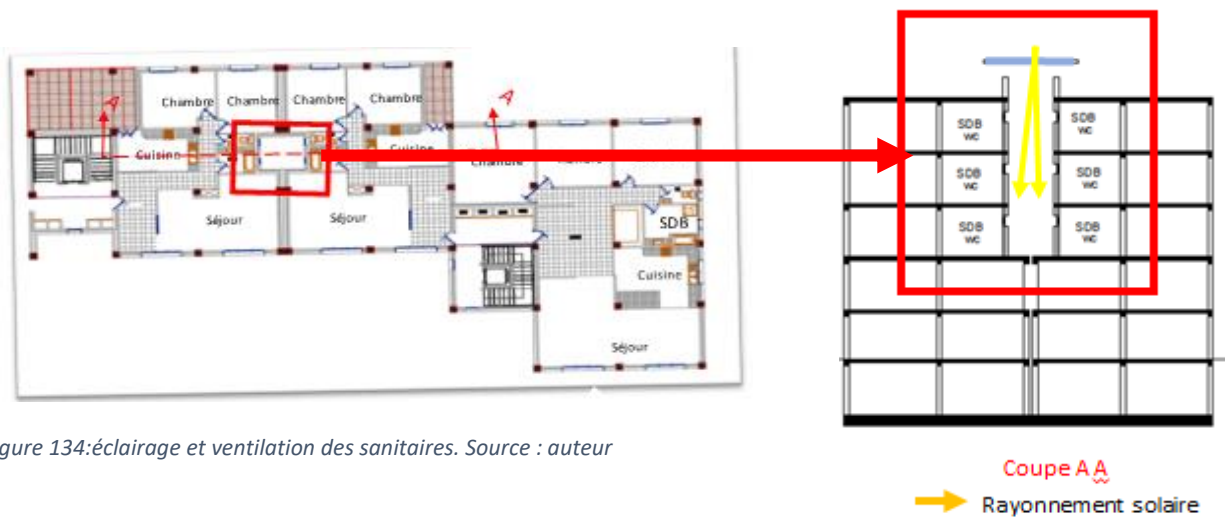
éclairage et ventilation des sanitaires. Source : auteur
